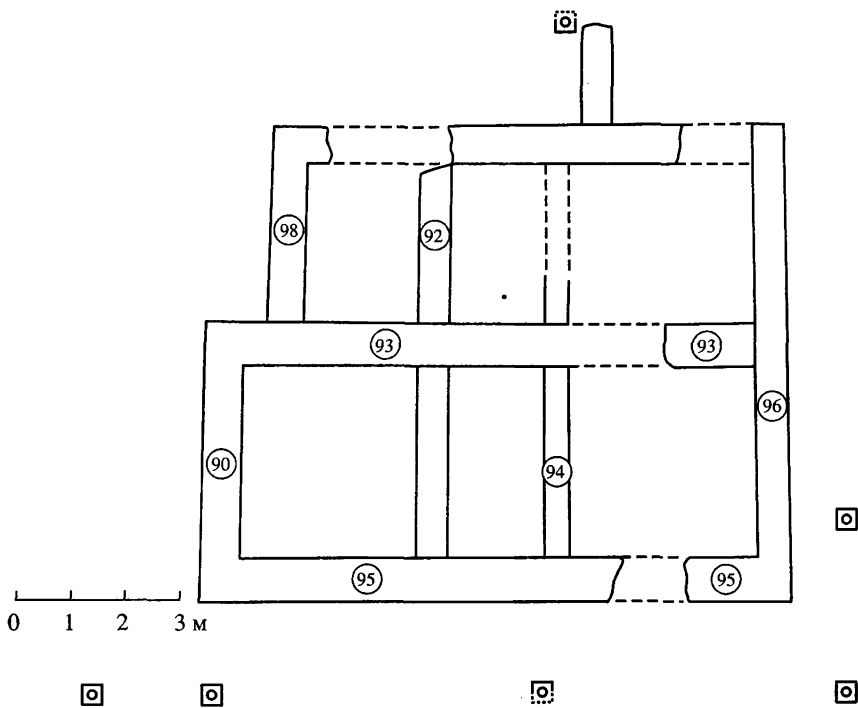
План здания второго строительного периода на пересечении главных продольной и поперечной улиц цитадели по И.А. Антоновой
